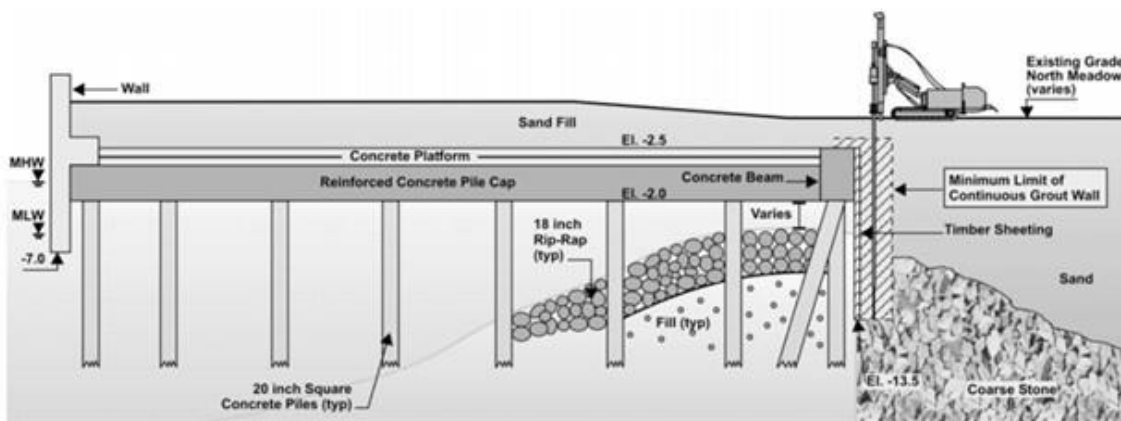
Поперечное сечение участка для устройства грунтоцементных колонн [15]
